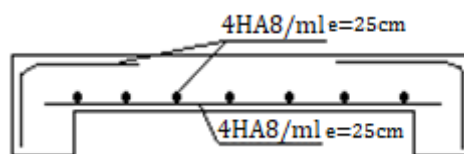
Schéma de ferrailage de la dalle sur 4 appuis
